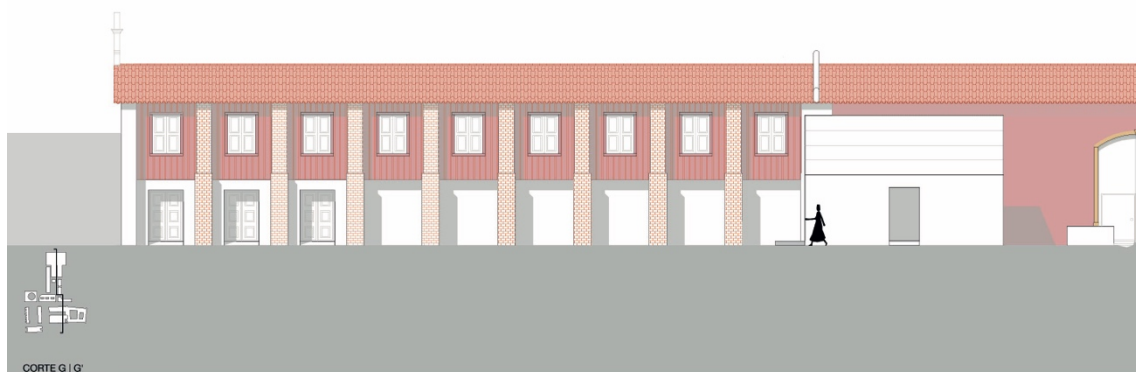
| Alçados e Planta piso térreo | Alçado dos Banheiros; Alçado das salas de aula e museu; planta dos banheiros zona de convívio e salas de aula | Nova Proposta da Quinta da Cardiga | Desenhos da autora
